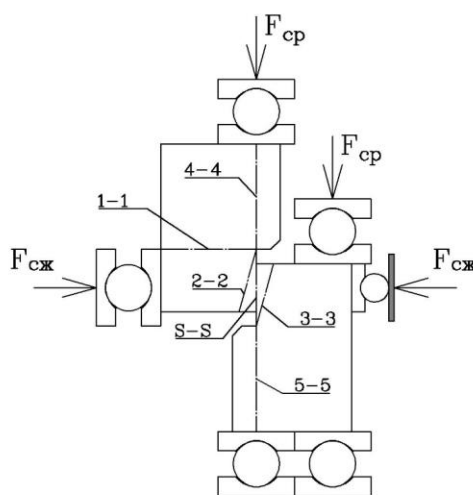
Схема экспериментального S-образного бетонного образца с указанием сечений возможного разрушения
